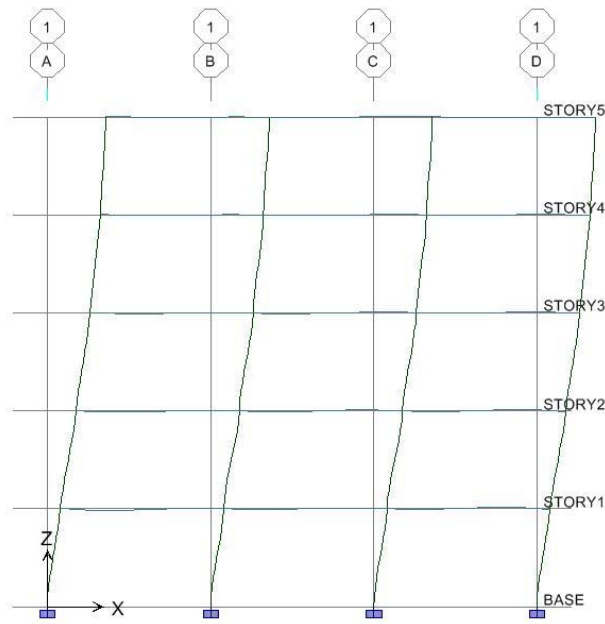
Vista deformada, estado de cargas para cálculo de rigidez en el pórtico 1 del primer y tercer modelo.
